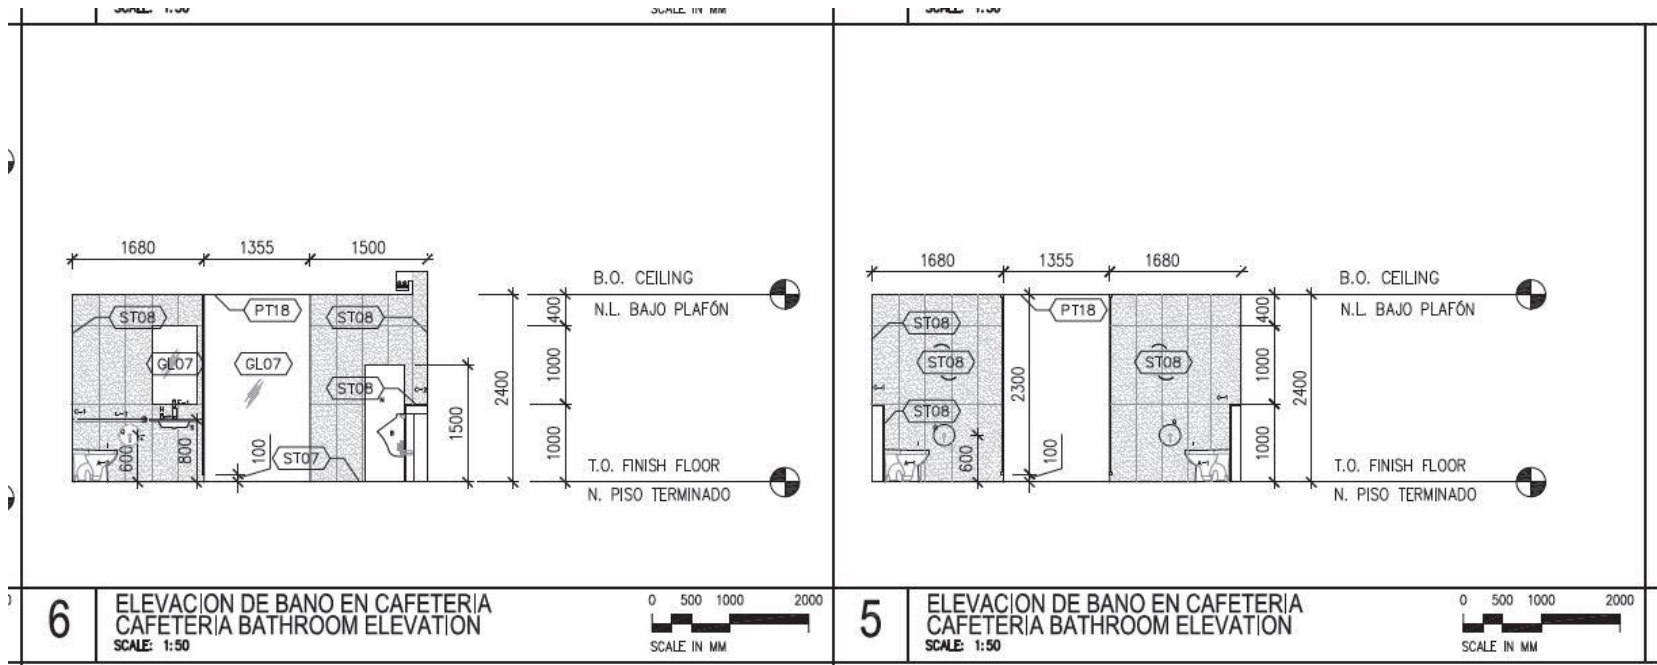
Fragmento plano TF-I-517, Elevaciones interiores comedor, tomado del set de planos de fit Out BBVA Bancomer, Copyright© 2014 Skimore, Owings & Merrill LLP.
